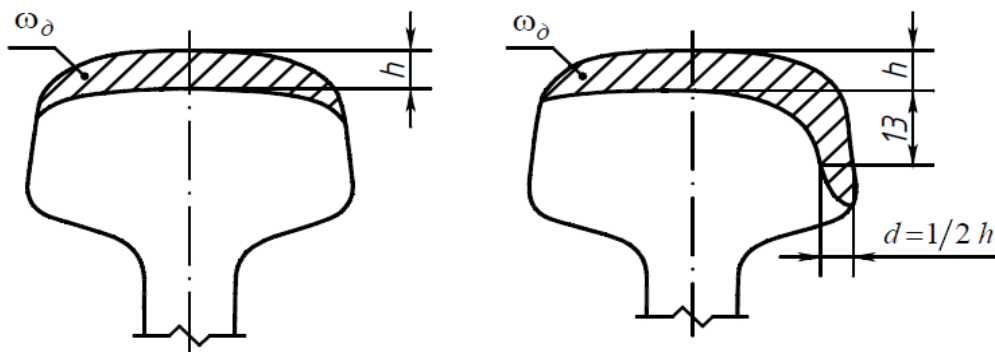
Вертикальний знос поверхні кочення головки і боковий знос робочої грані рейки
